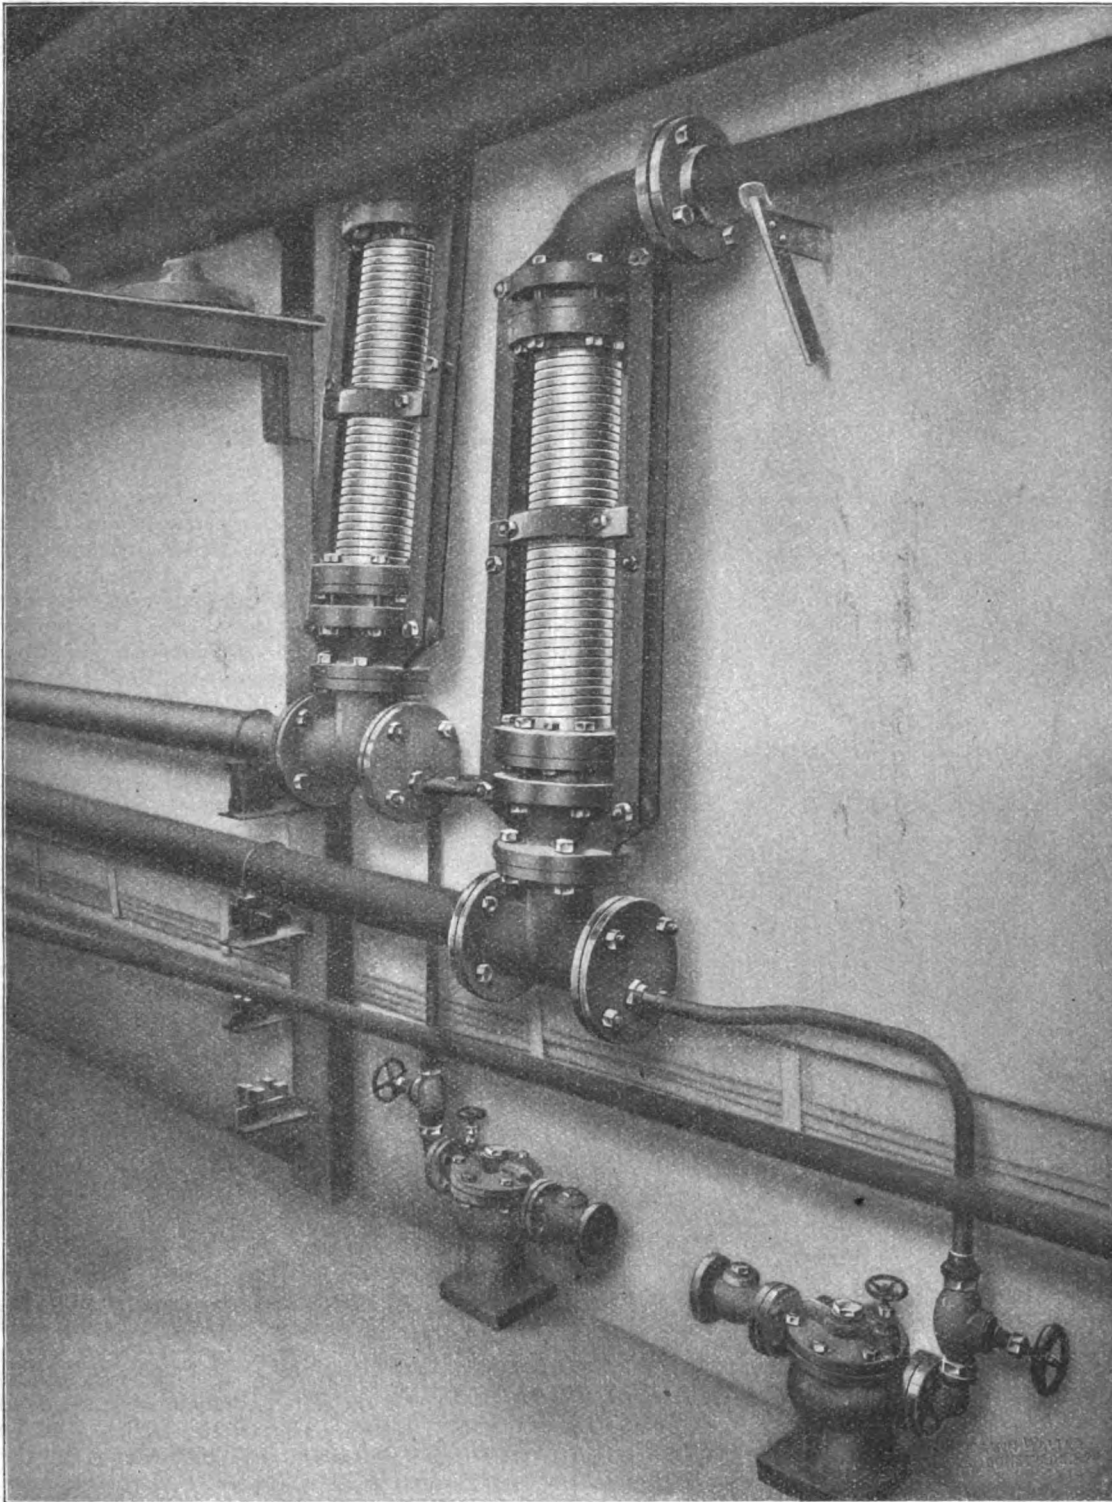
Wärmeausgleicher aus geschweißtem Metallschlauch für Dampfhochdruckleitungen, eingebaut im Krankenhaus St. Georg in Leipzig.
